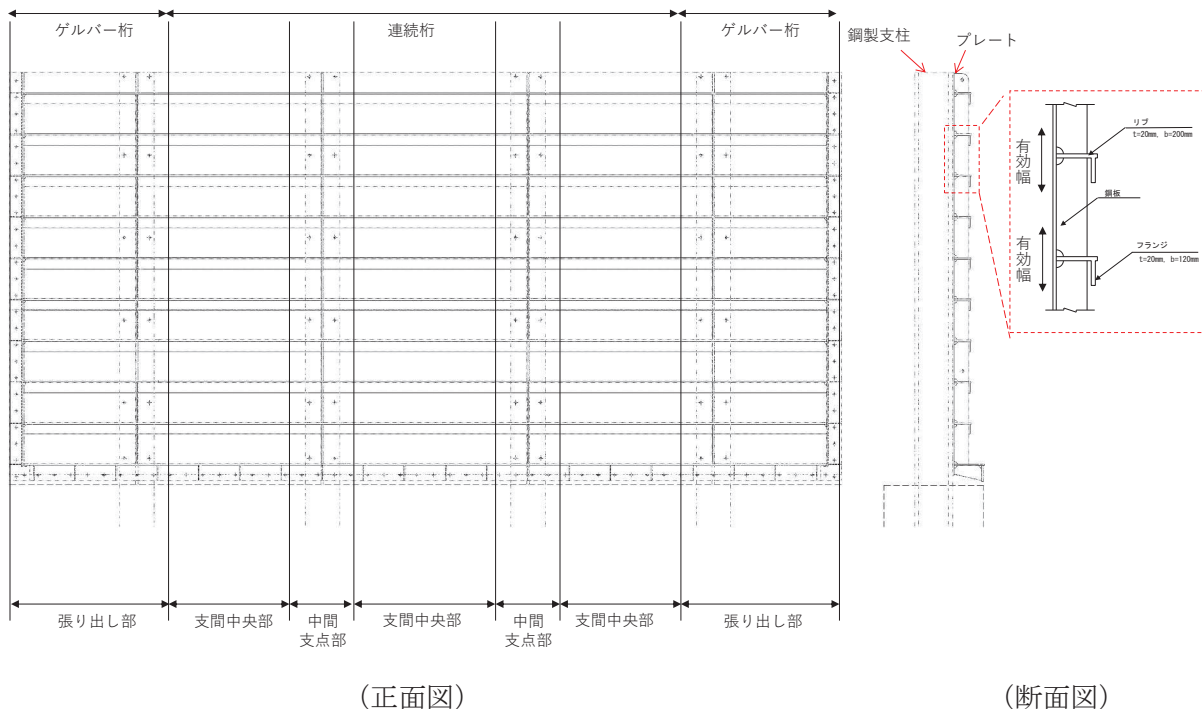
鋼板の構造図 (正面図, 断面図)
